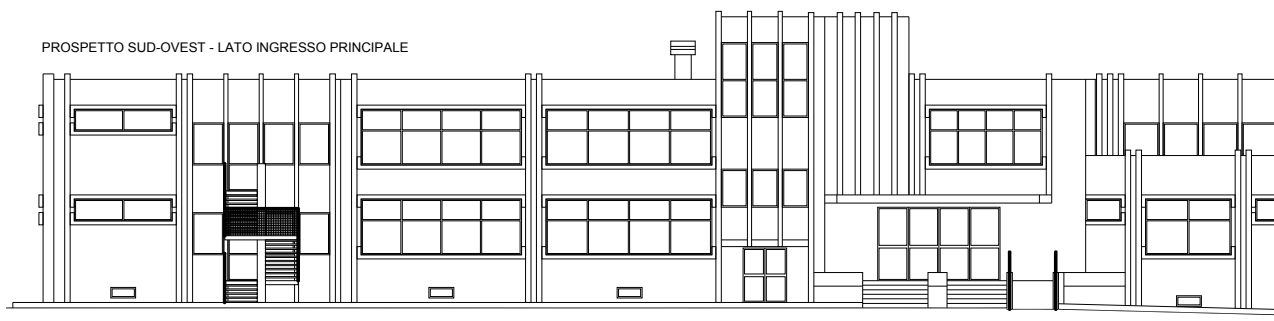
Prospetto Lato Ingresso Principale – Stato Futuro
